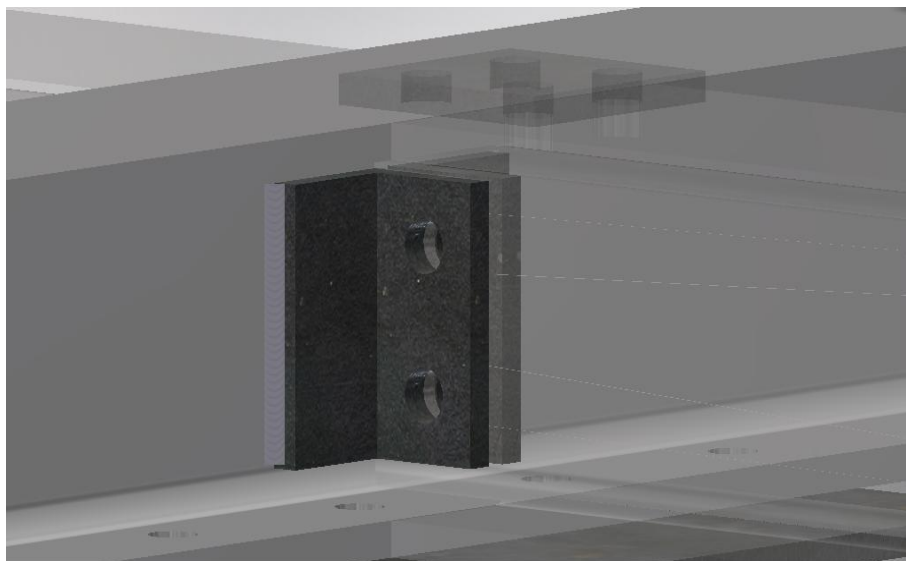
Cordón de soldadura entre placa 1 viga principal.
